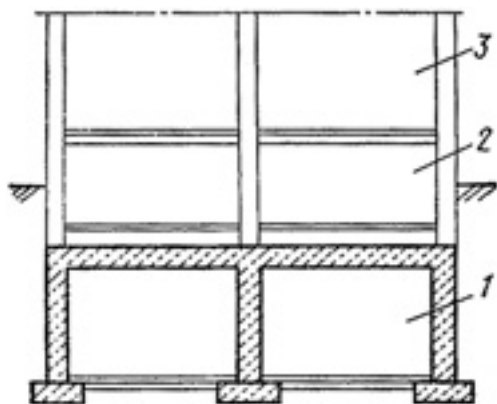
Поперечный разрез убежища, расположенного под техническим подпольем в жилом здании: 1 — помещение убежища; 2 — техническое подполье; 3 — помещения первого этажа здания
